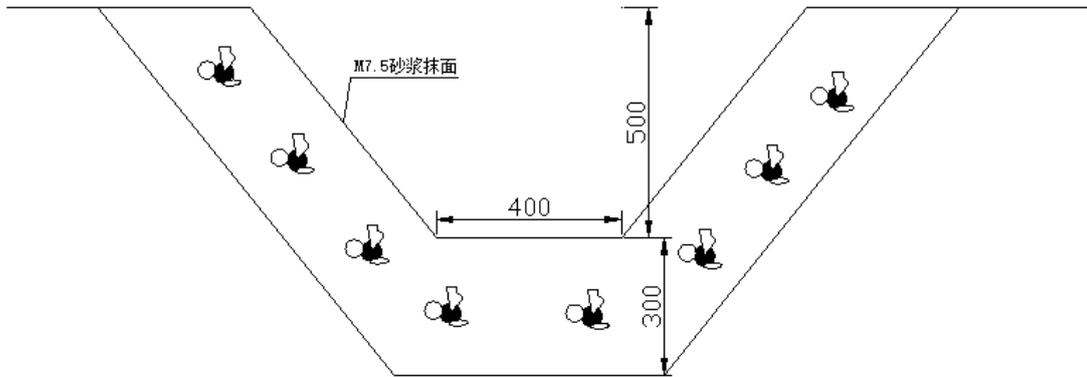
风电机场排水沟典型断面图（单位:mm）
